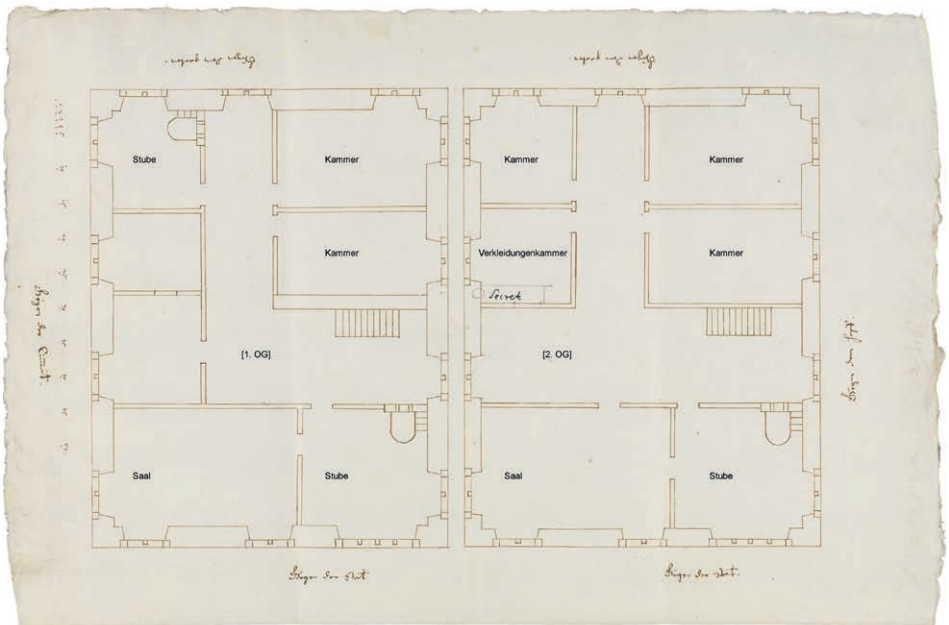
Grundrisse des 1. (links) und des 2. OG (rechts) für das Amtshaus des Klosters St. Blasien in Zürich-Unterstrass, wohl 1693
